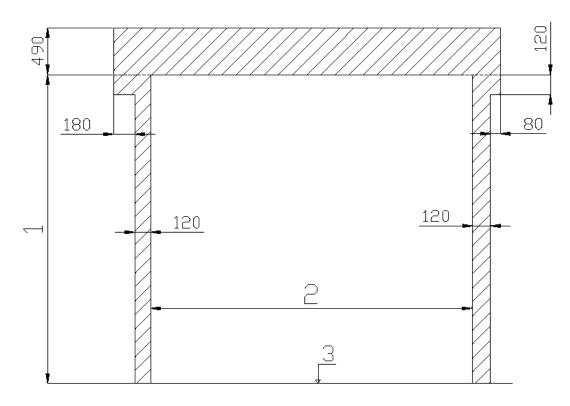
Ausführung Motor links (Motor rechts spiegelbildlich)
